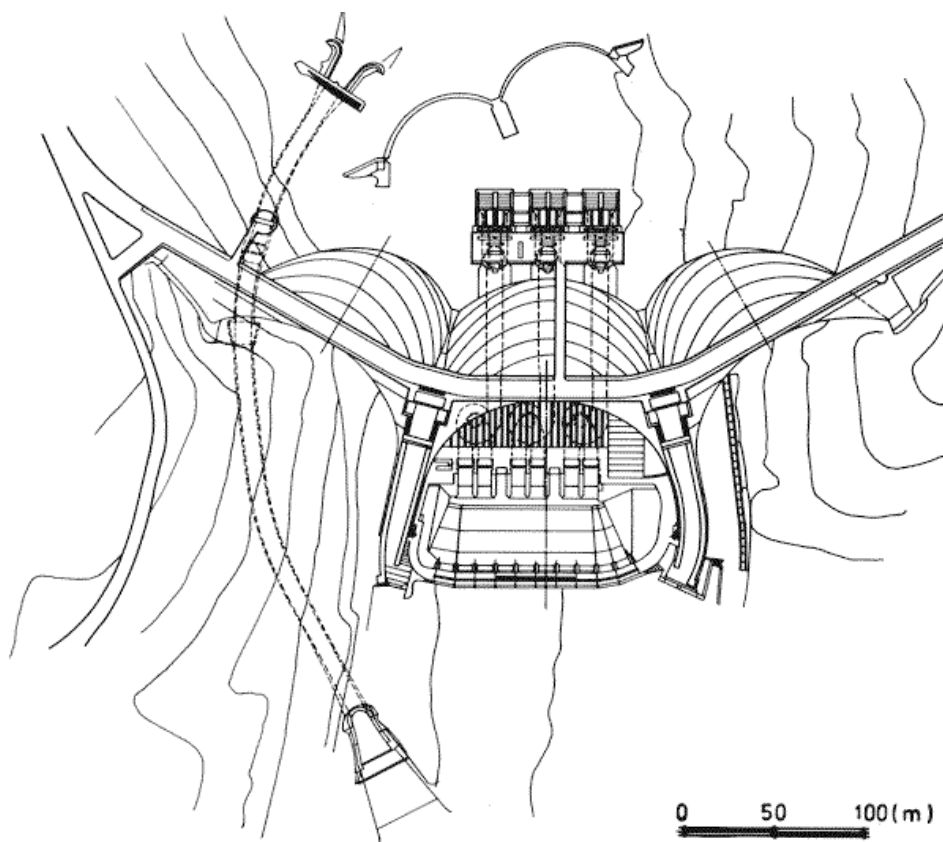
Planta da barragem da Aguieira (Fonte: <http://cnpgb.inag.pt>)
